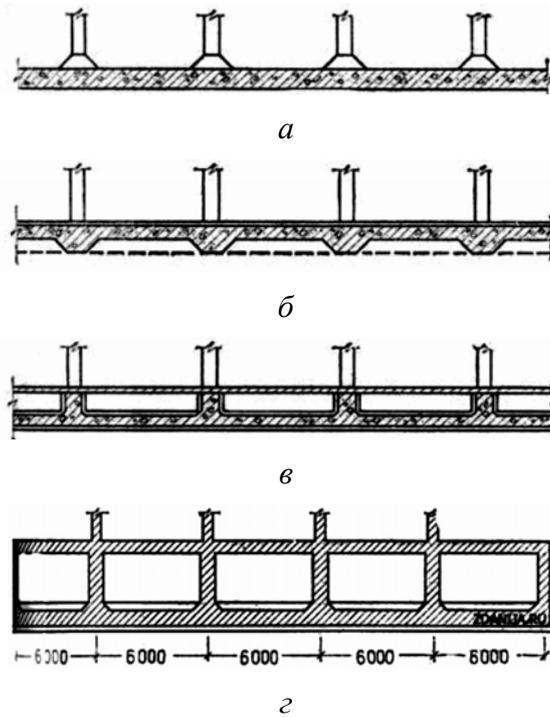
Конструкция сплошных фундаментов: *a* — перекрестная конструкция; *б, в* — варианты устройства сплошной фундаментной плиты; *г* — коробчатая конструкция фундаментов
